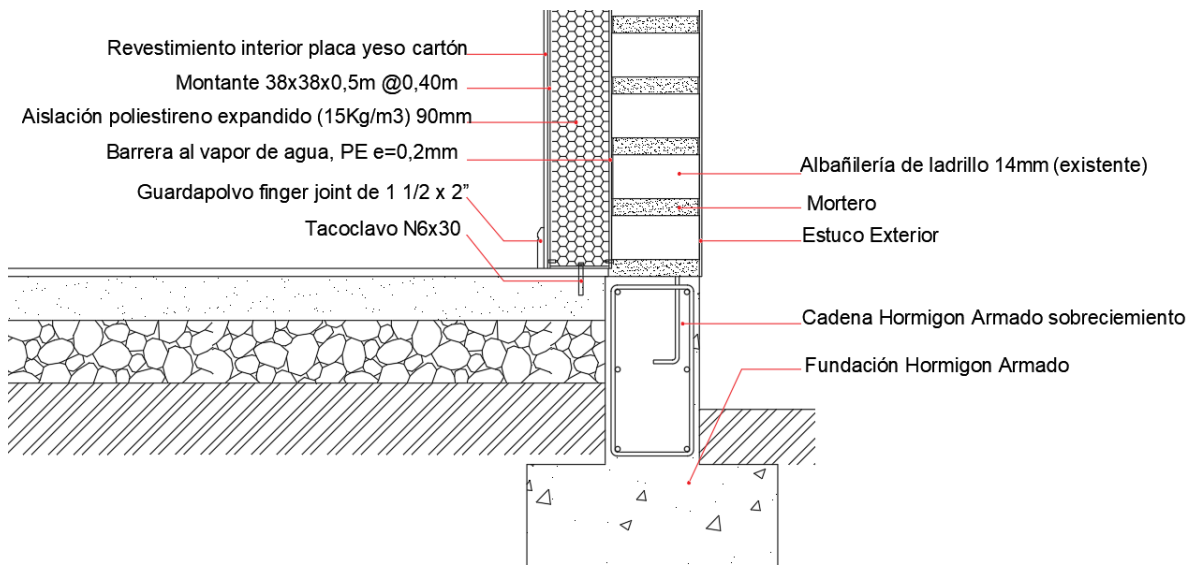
Escantillón muro suelo existente- muro primer piso . Fuente: Elaboración Propia.
